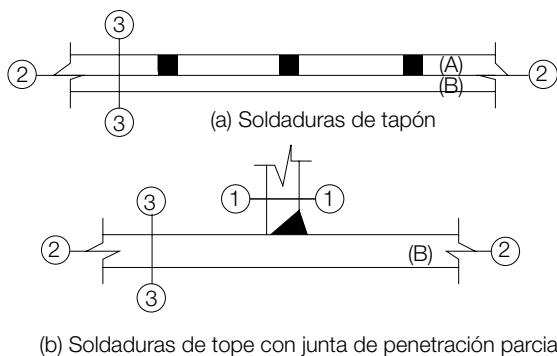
Planos de corte para soldaduras de tapón y de tope con junta de penetración parcial (PJP).
